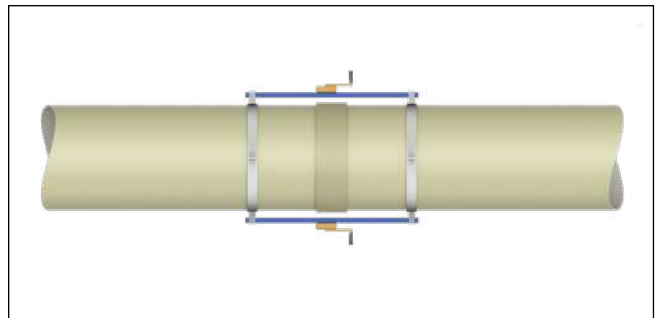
Exemplo de um auxiliar de instalação para a desmontagem de tubos
